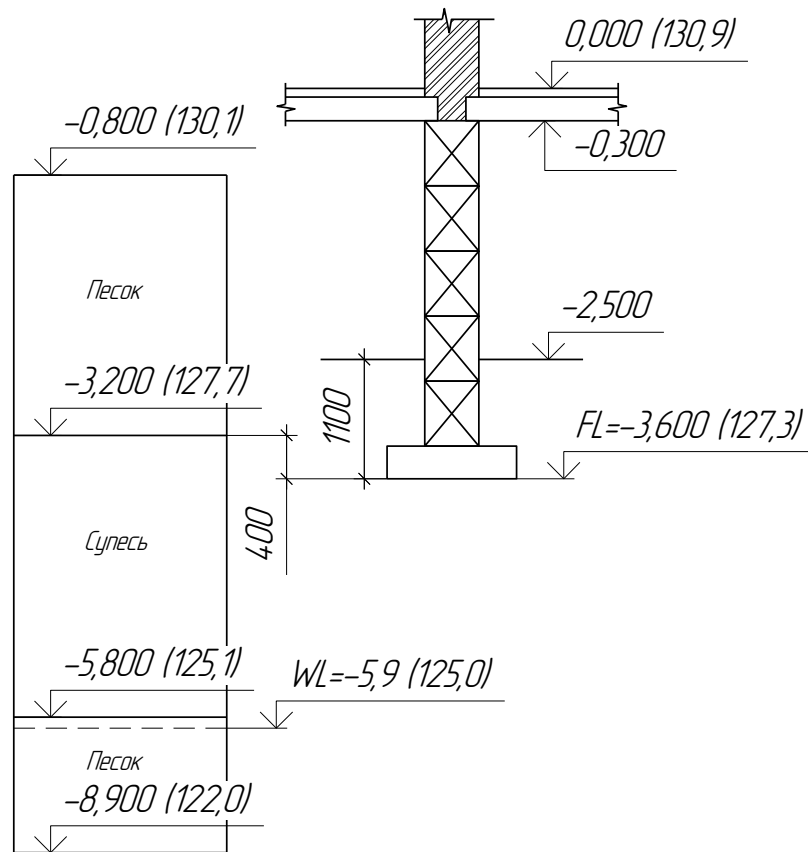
Розріз по фундаменту будівлі та ІГЕ по глибині ґрунта
